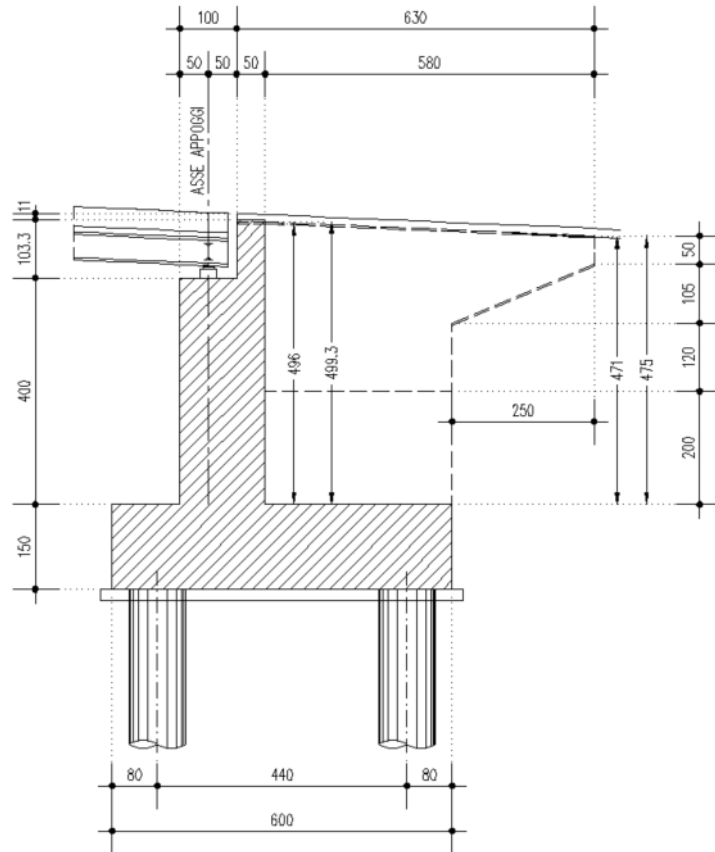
Spalla B – Sezione in asse tracciamento
